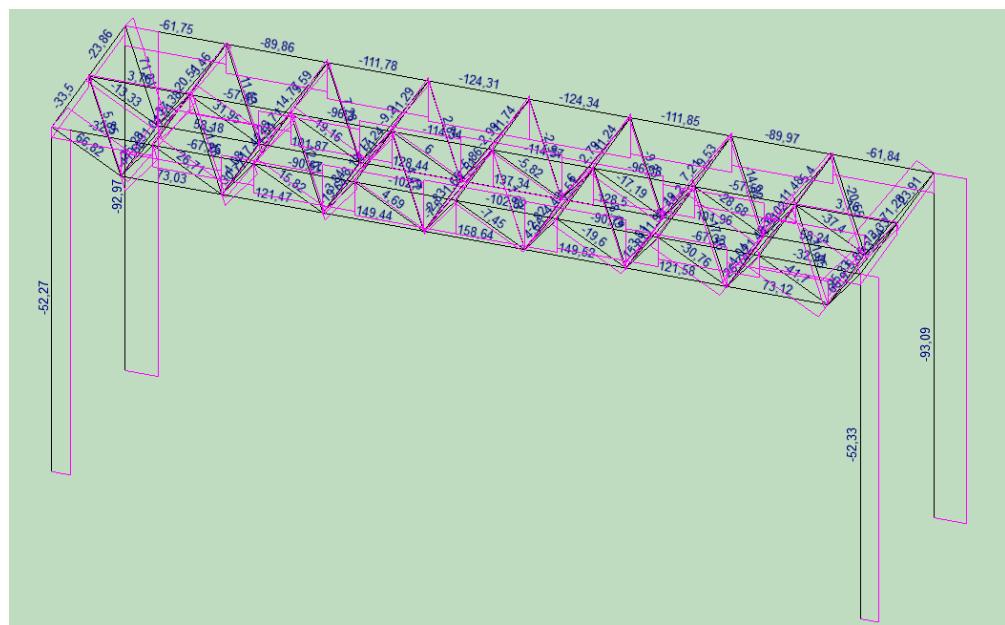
Расчетная схема поперечной рамы с постоянными нагрузками
